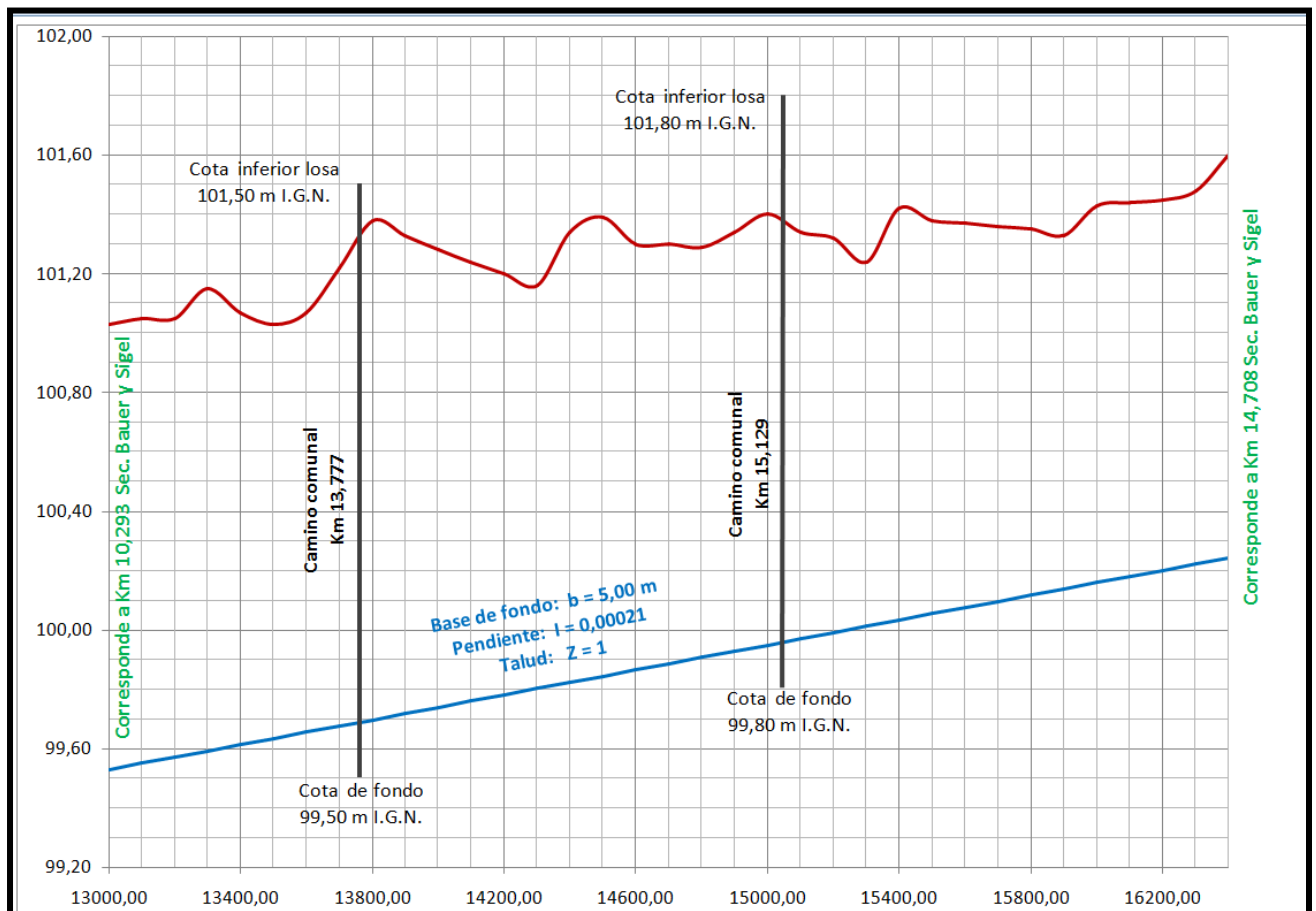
Perfil longitudinal y ubicación de alcantarillas
